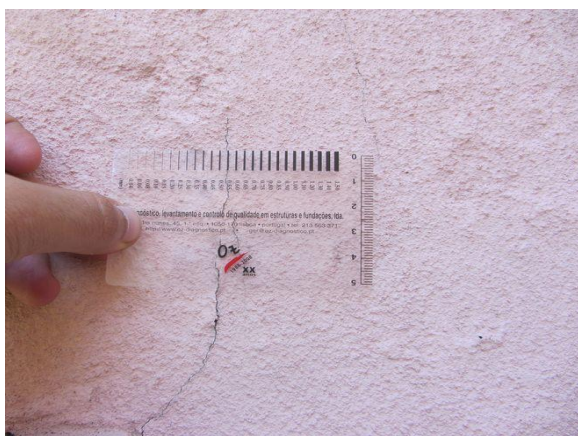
Medidor de fissuras - Fissura com 0,50mm de largura. Fonte: Autor, outubro 2017.
